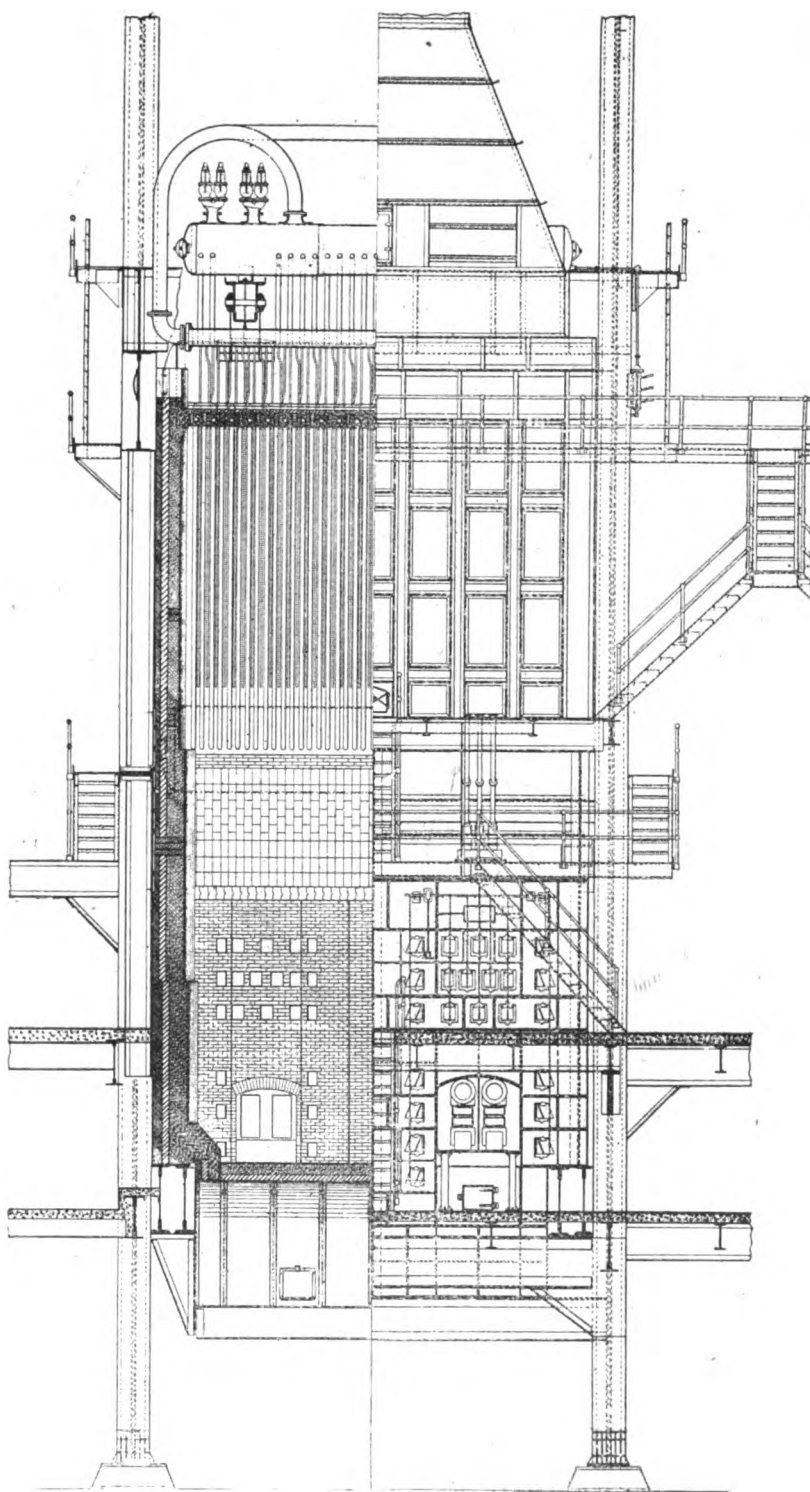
Chaudière de l'usine de « River Rouge ».
